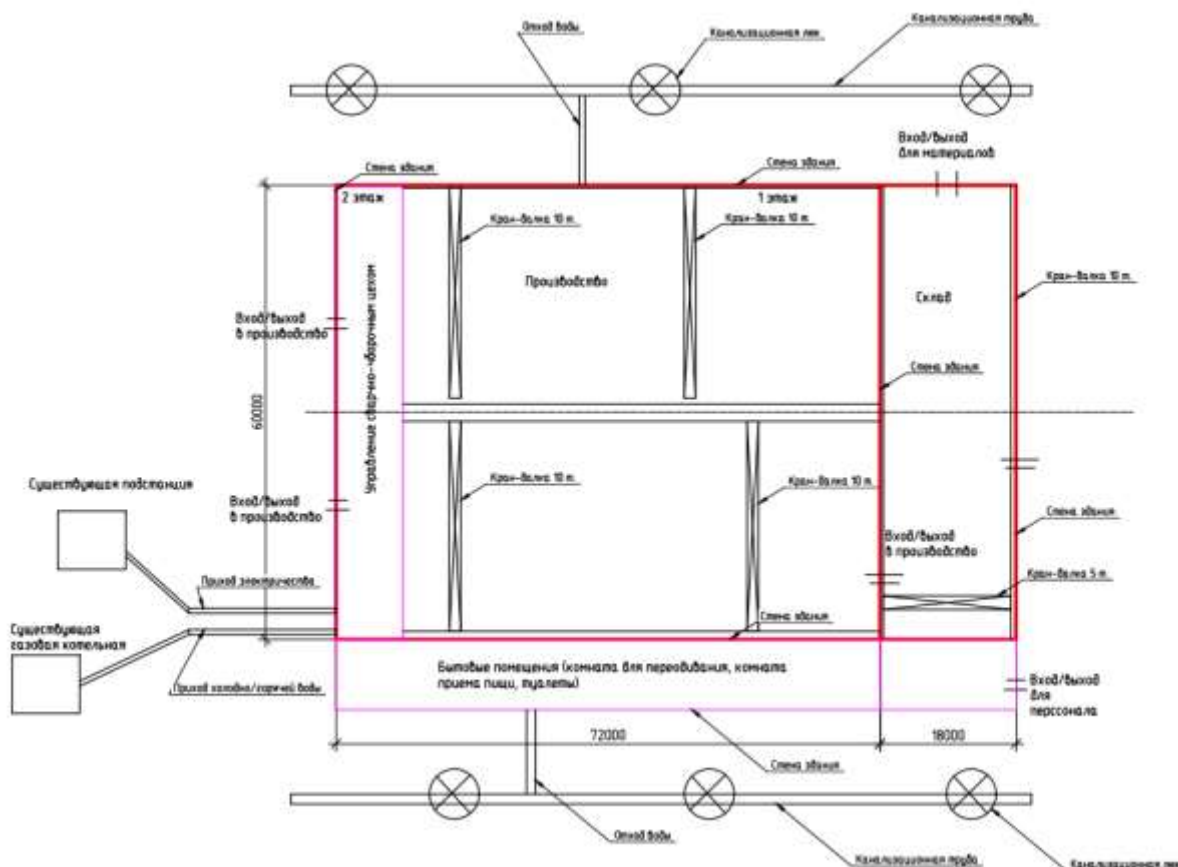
Планировочная концепция здания сварочно-сборочного цеха
